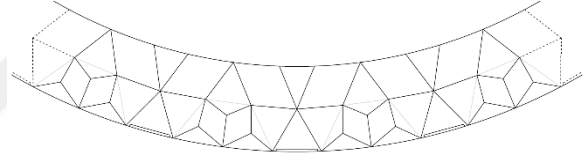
Bursa Muradiye Cami'nin Taçkapısının Arkasındaki Mukarnaslı Tavan Geçişi, Solda Çizimi.
